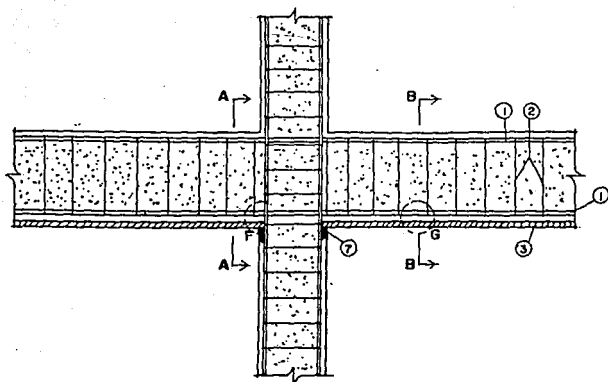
Encamisado por flexion y cortante en vigas de concreto reforzado a todo al rededor (Ref. 15)
